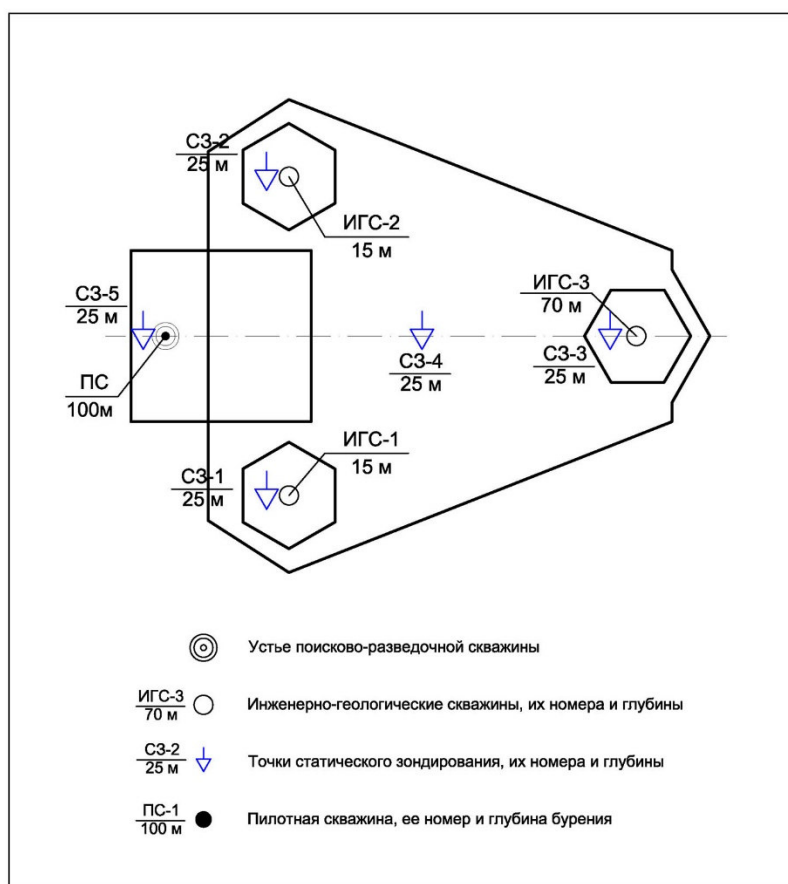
Принципиальная схема размещения точек геотехнических работ на месте постановки СПБУ
